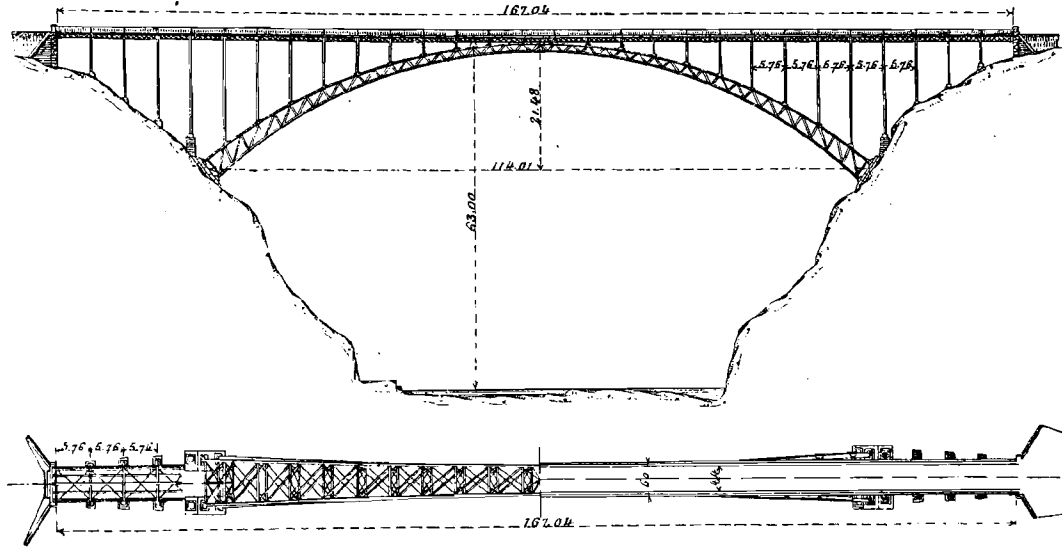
et 5. — Plan et élévation du projet adopté. (Echelle de 1 : 1000.)
